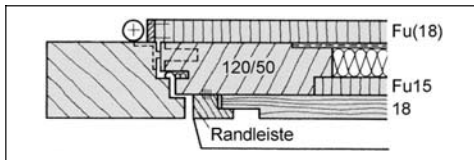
Aufgedoppelte Haustür mit eingelegerter Wärmedämmung und Dampfsperre
